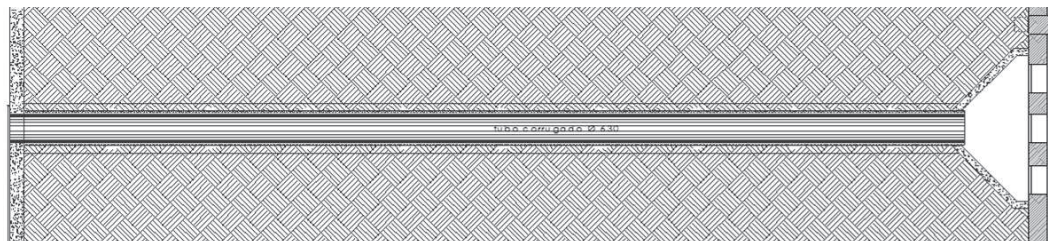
Planta de representação das bocas de lobo e tubo de ventilação.
